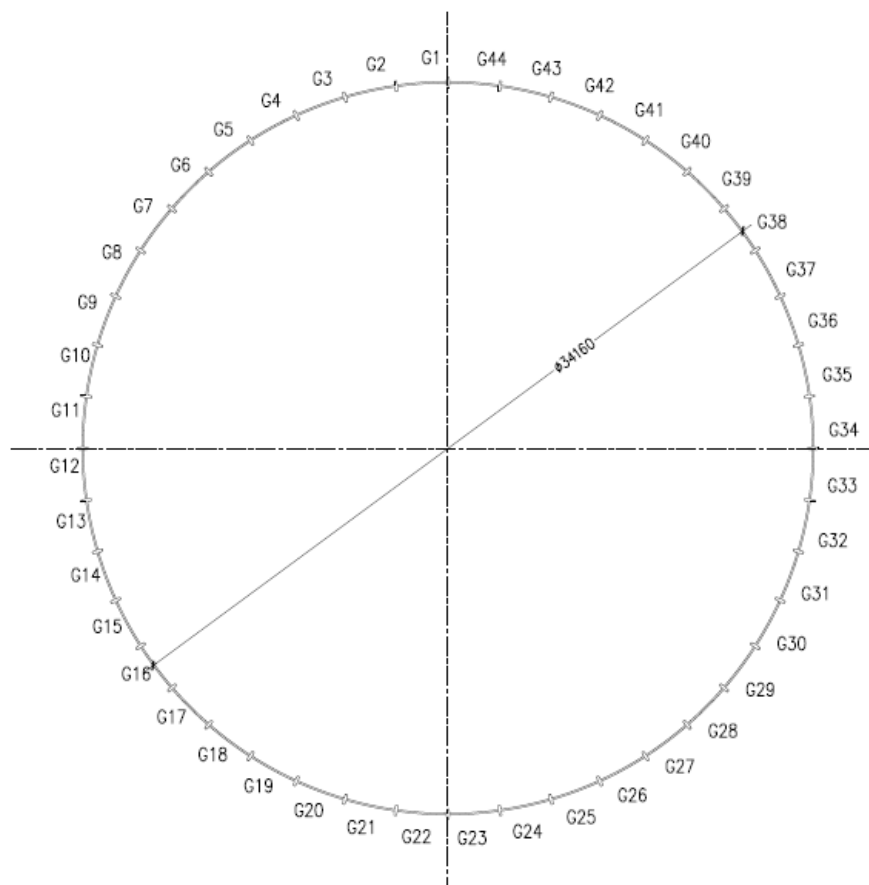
Vista in pianta bassa (a quota +4.940) della TRG1
